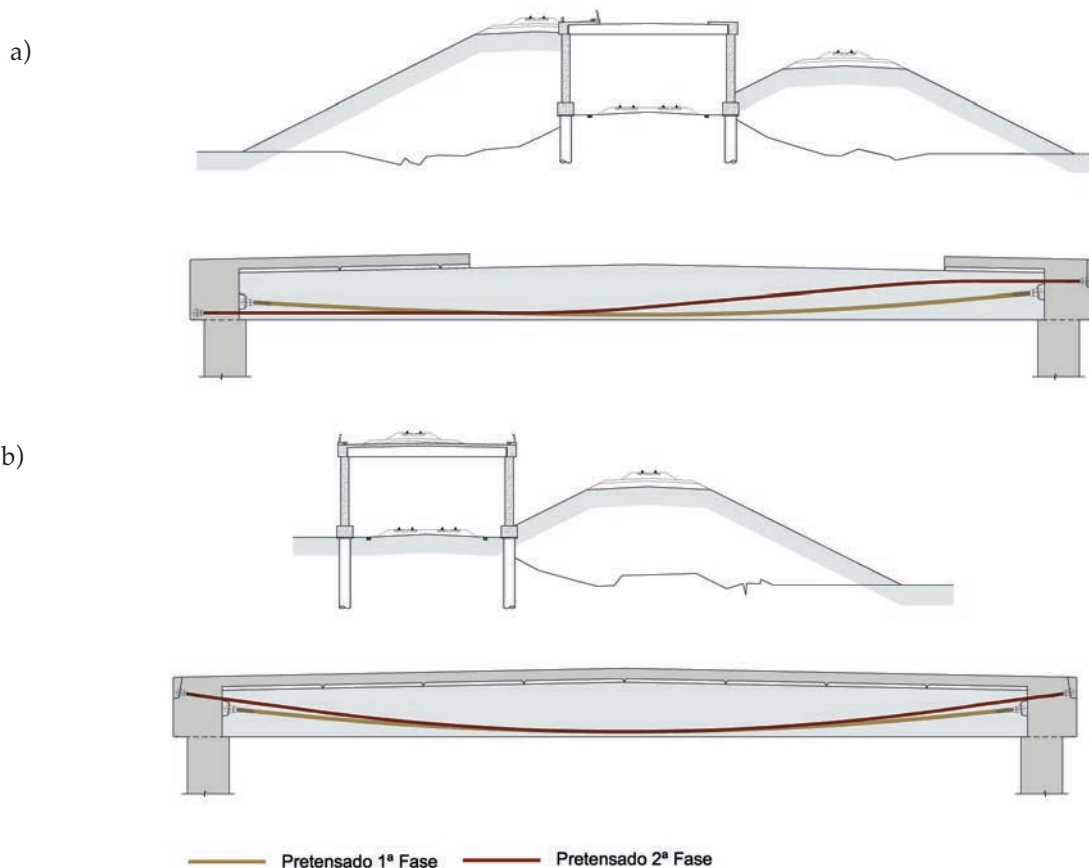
Secciones transversales y pretensado de las vigas de la pérgola en la L.A.V. Madrid-Toledo en Alameda de la Sagra; a) Zonas extremas; b) Zona central
